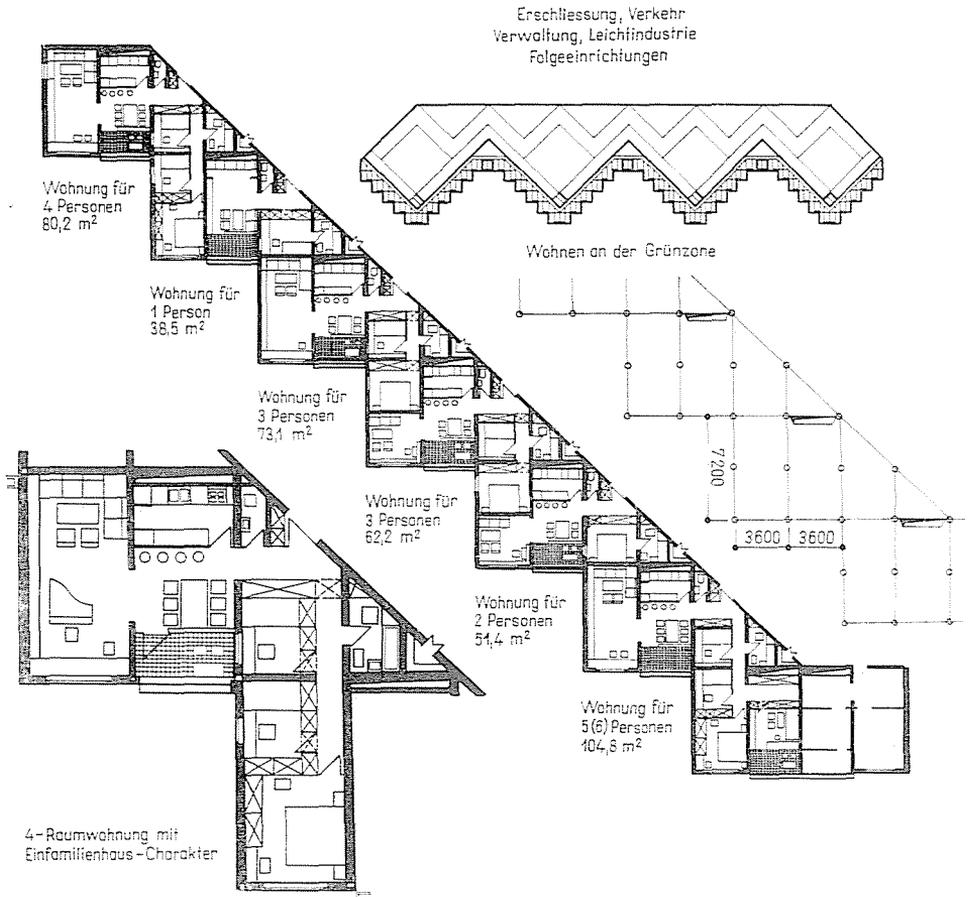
Süd-orientierter Grundriß in 9 Mp-Bauweise. Alle Elemente sind raumgroß, so daß die Fugen auf ein Minimum reduziert werden. Der Grundriß zeigt, daß die Anwendung raumgroßer Elemente viele Variationen zuläßt
